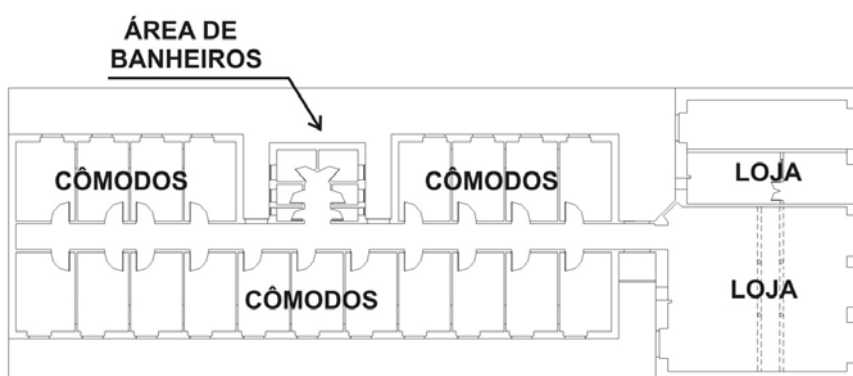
Imóvel situado à rua Visconde de Maranguape, 9 – Planta baixa do primeiro pavimento (CEDAE, s.d., adaptado pela autora).
